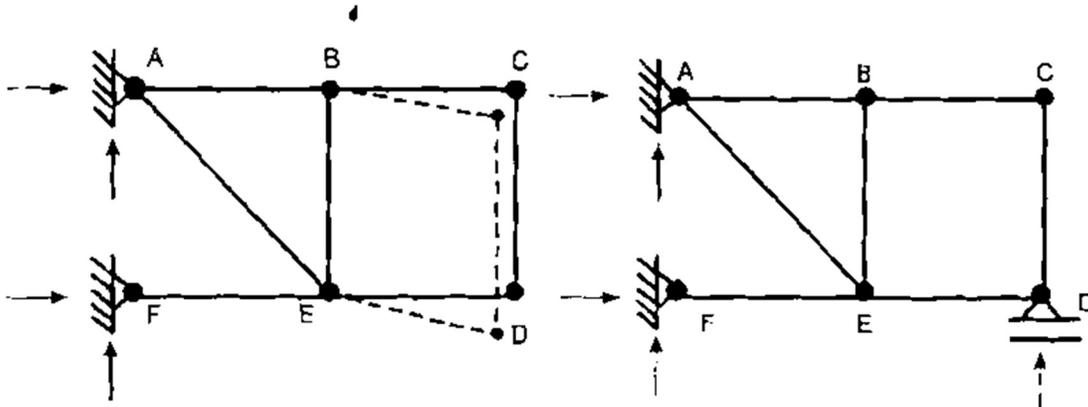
(E) estructura inestable y estructuras apoyados por falta de estabilidad.
